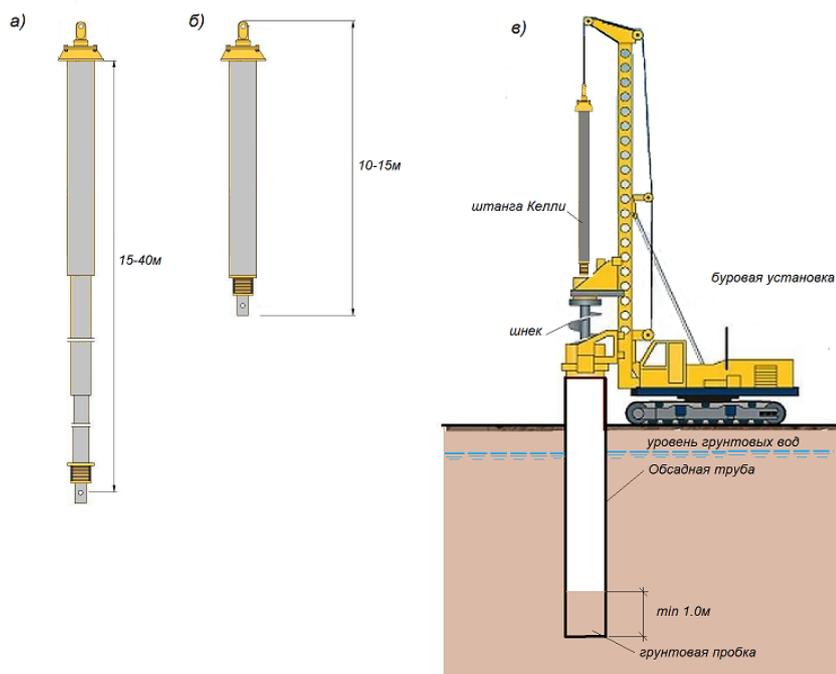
Бурение скважин при помощи штанги Келли: а) – штанга Келли в разложенном состоянии; б) - то же в собранном; в) – бурение в обсадной трубе в водонасыщенных грунтах
